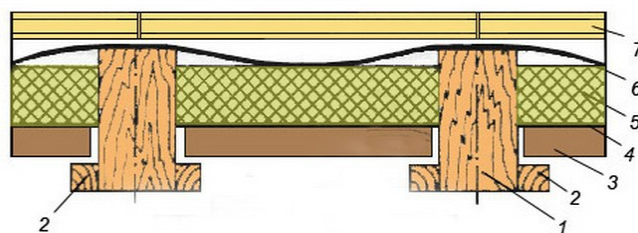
Балкове перекриття по дерев'яних балках:
